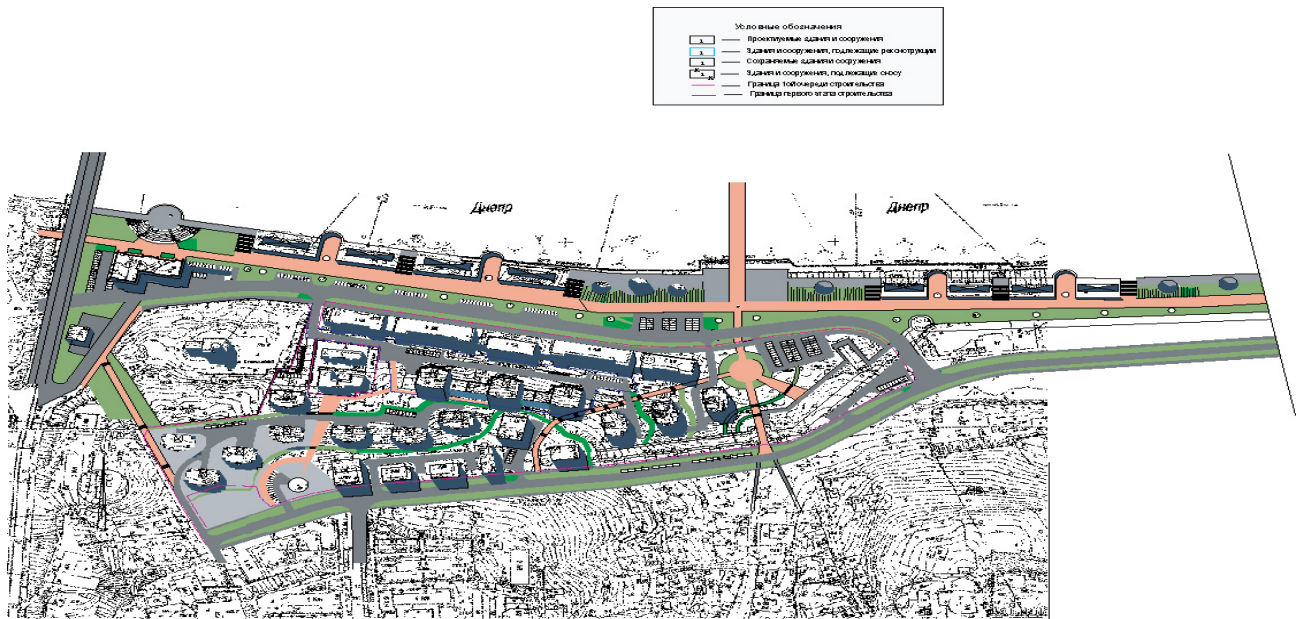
Планировочное решение реконструкции набережной реки Днепр
